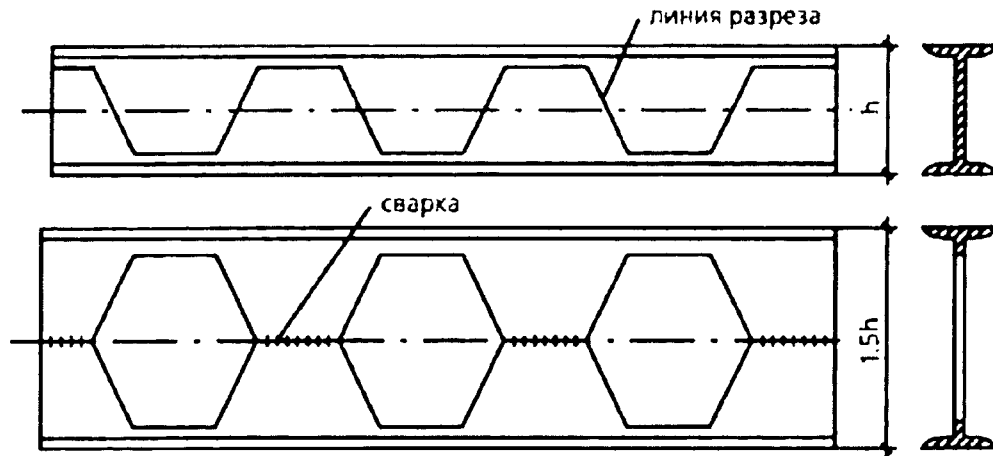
Перфорированная балка, изготовленная путем разрезания и сварки стенки прокатного двутавра
